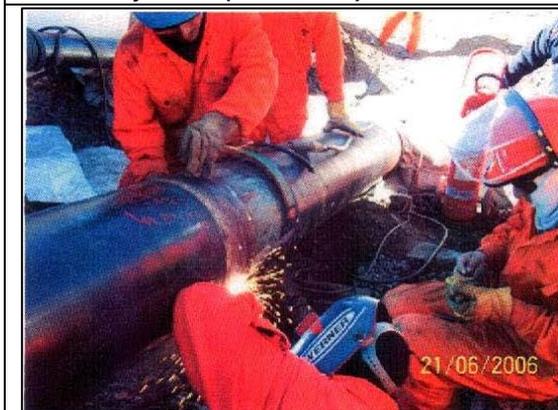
Soldadura del tramo reemplazado. (21.06.2006)
